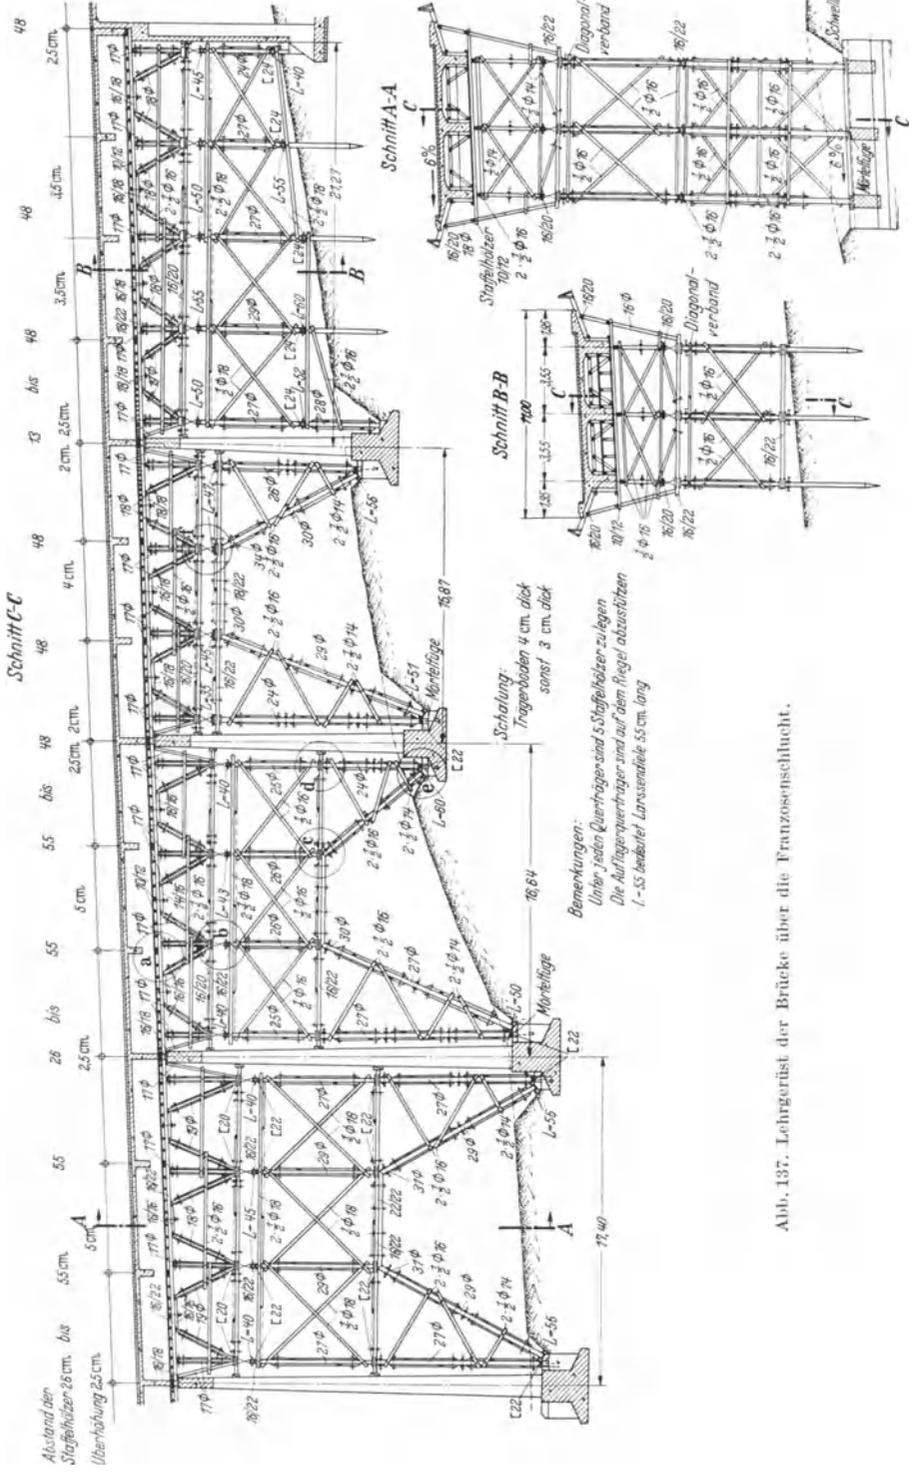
Lehrgerüst der Brücke über die Franzosen Schlucht.
